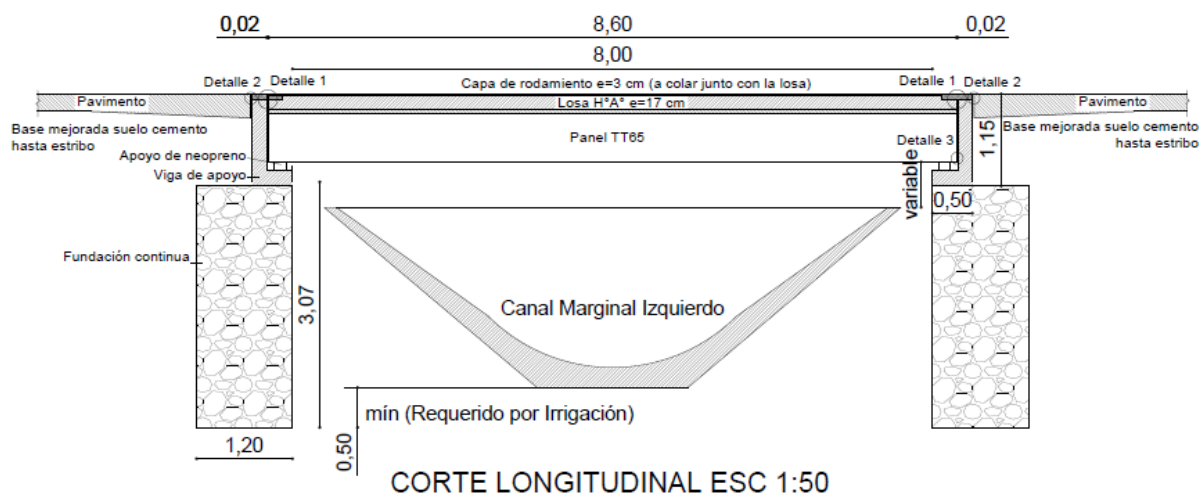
Detalle transversal de puente sobre canal marginal, similar al propuesto
